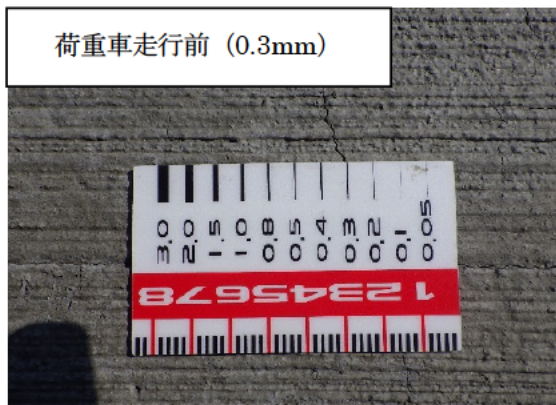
観察されたプラスチック収縮ひび割れ
